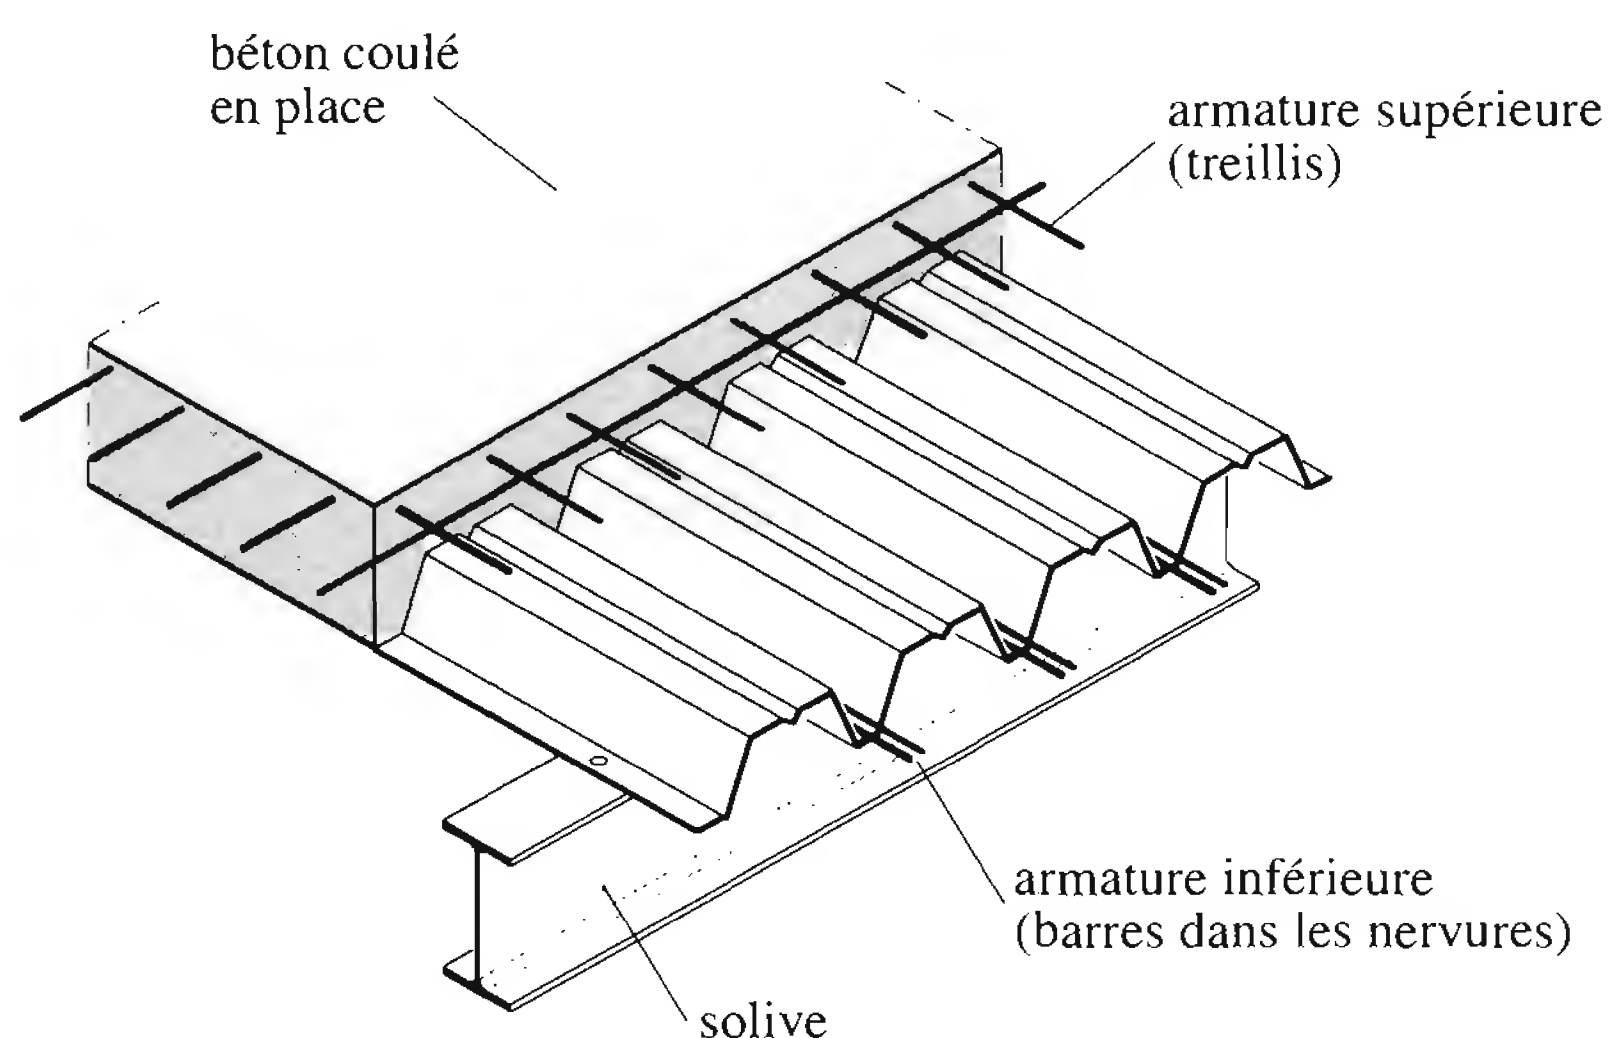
Dalle sur coffrage perdu en tôle profilée.
